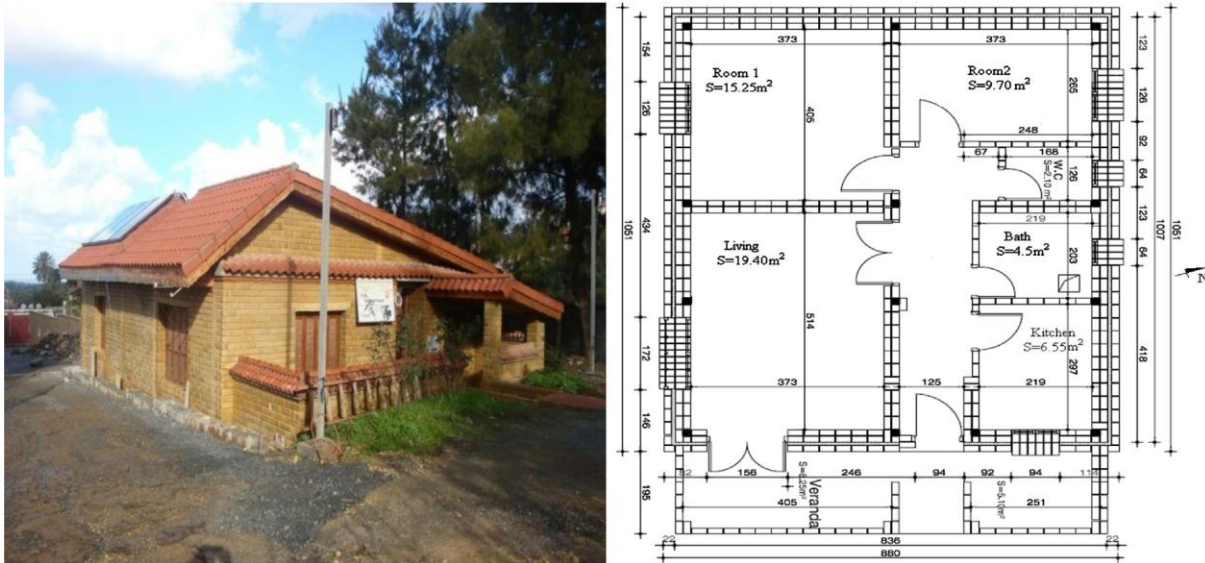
Le projet pilote du consortium CDER/CNERIB : photo à gauche et plan à droite. Source : (Imessad, et al. 2014)
